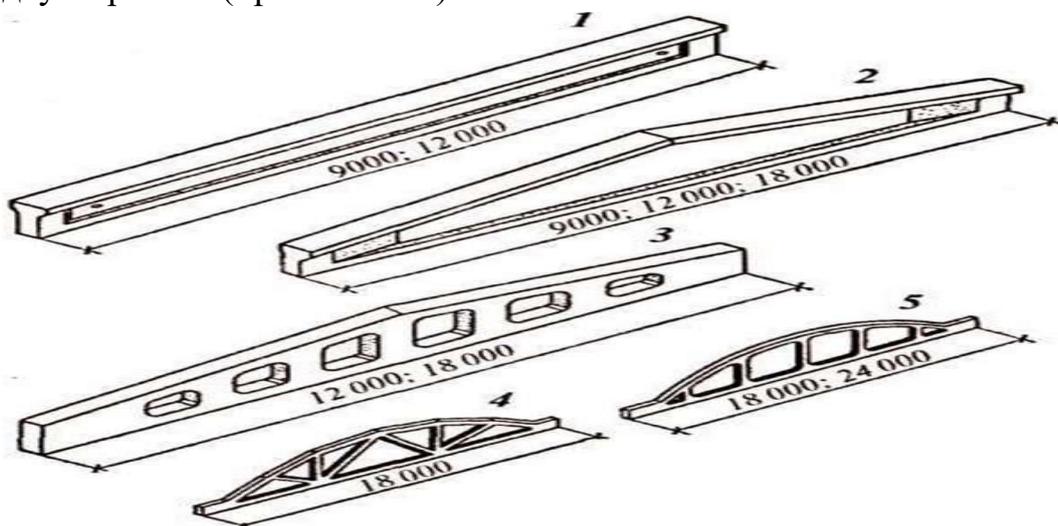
односкатная балка; 2 — двускатная балка; 3 — решетчатая балка; 4 — сегментная раскосная ферма; 5 — арочная безраскосная ферма
